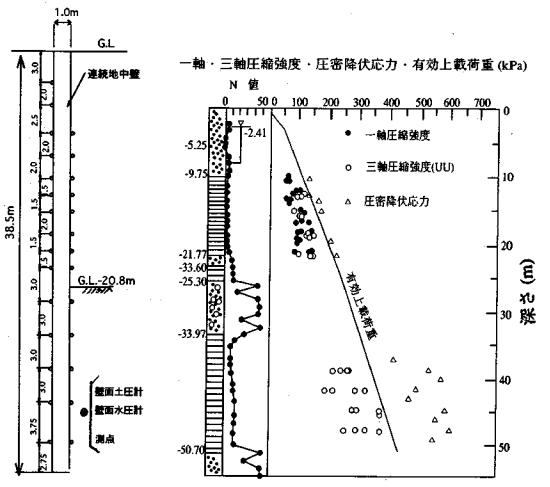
計測器設置位置図 図-3 地盤状態 (A 地点土留め工)
